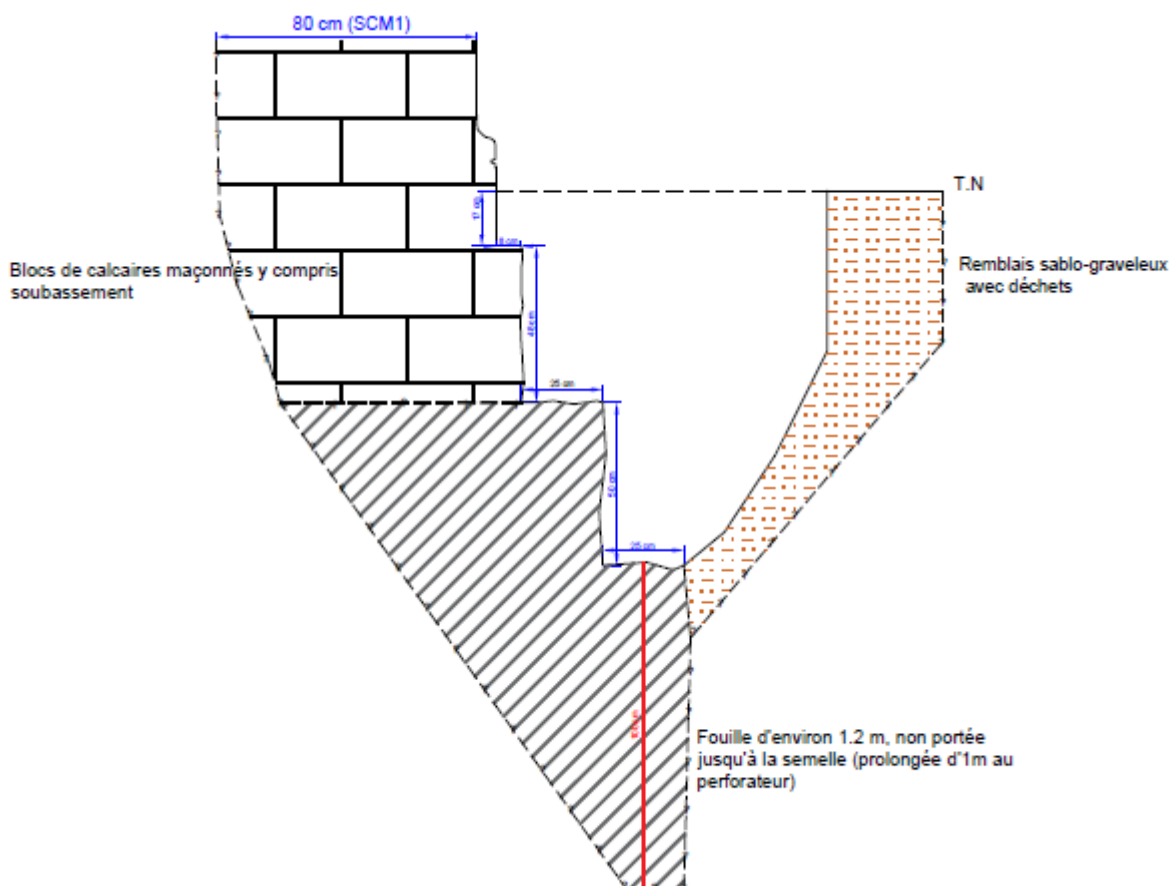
Relevé de la fouille F1 sur la fondation du mur M1 [ET -04] / Ginger CEBTP / Mai 2020
